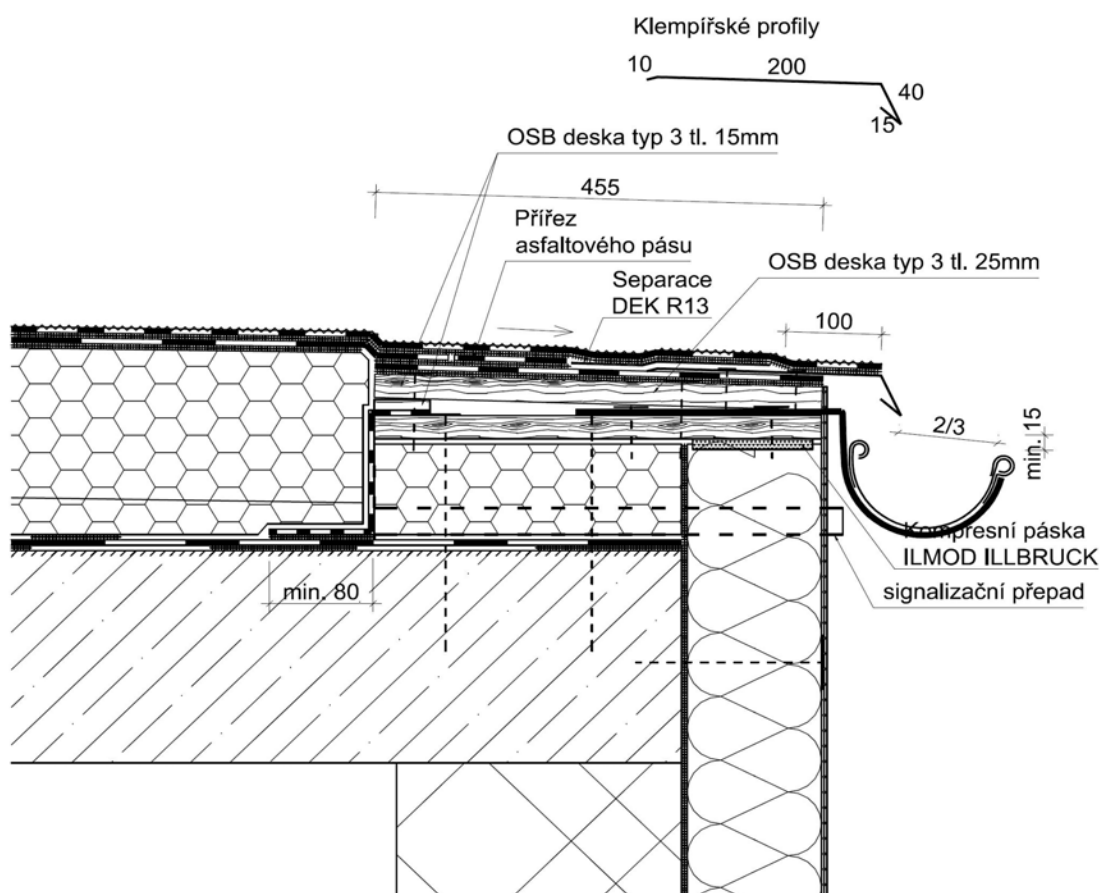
Detail ukončení hydroizolace na atice (skladba DEKROOF 03)
